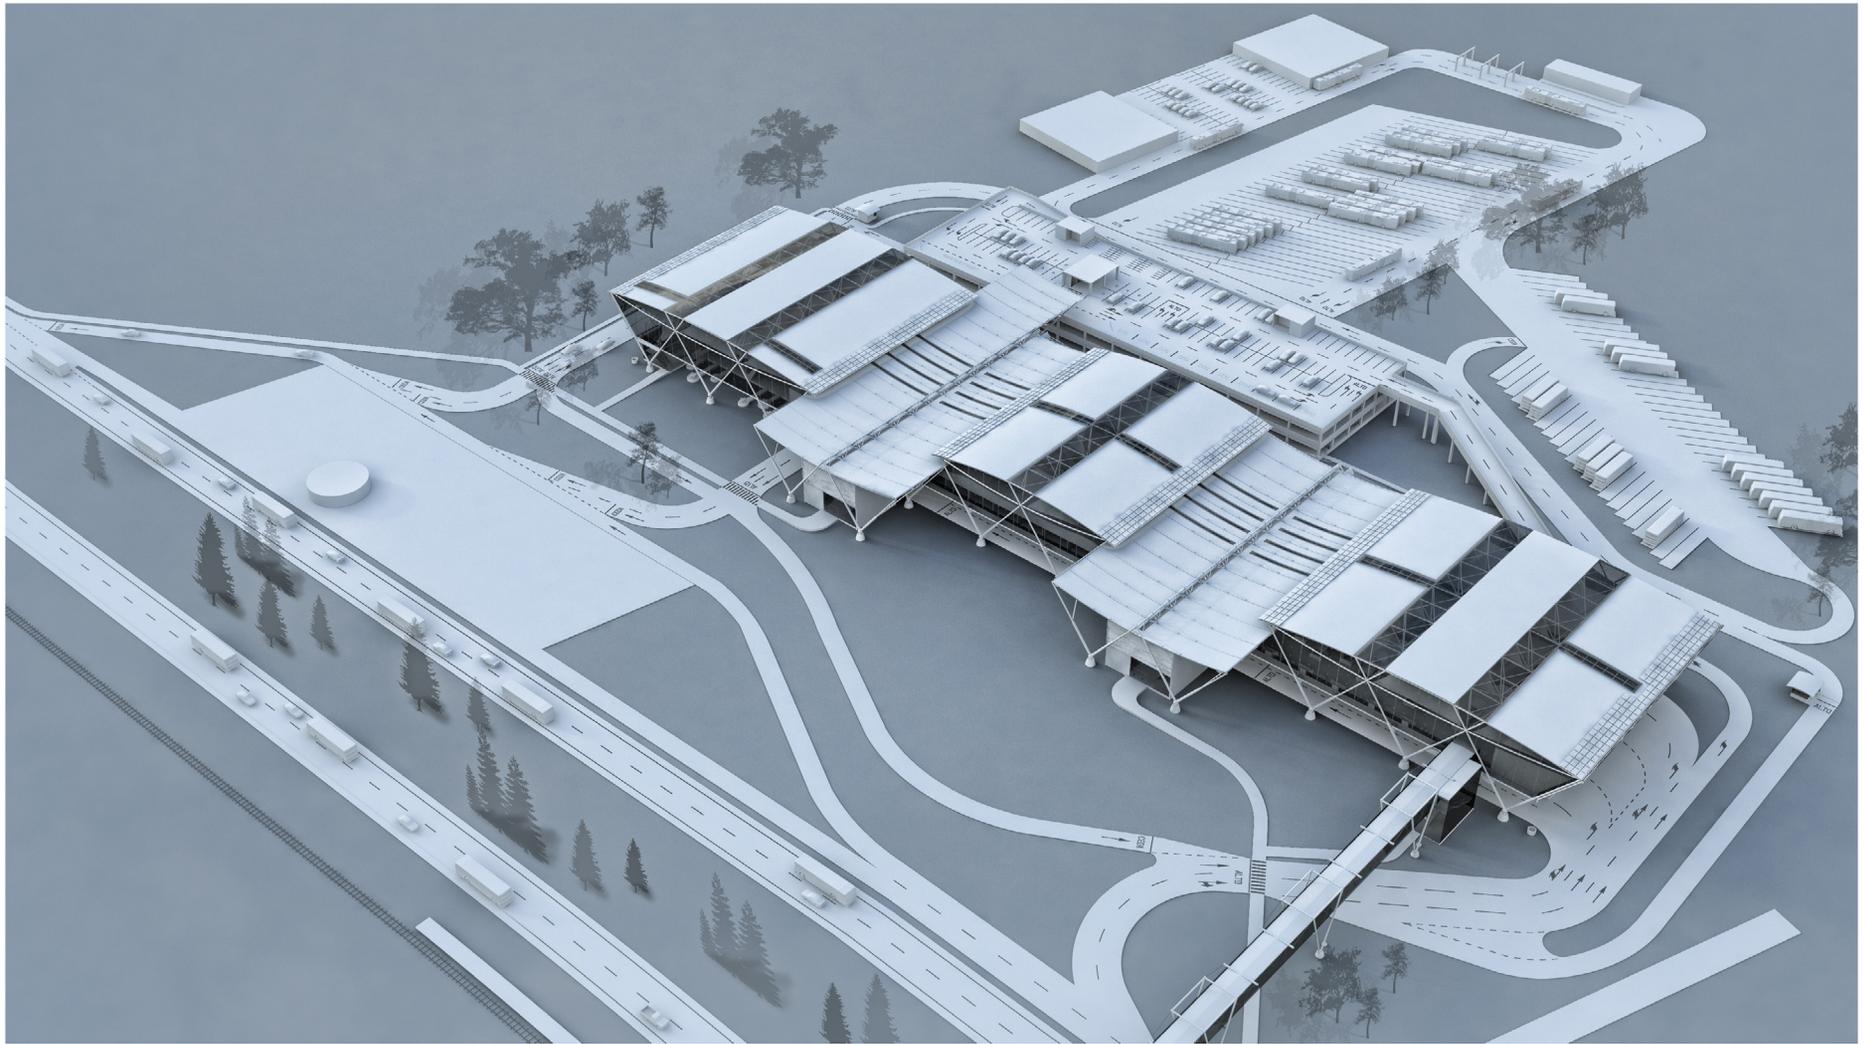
Vista aérea del conjunto desde el noroeste. Autoría propia. 2015.
